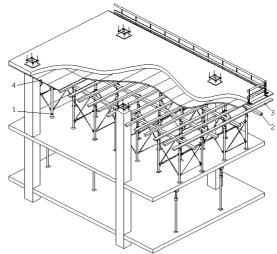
Схема опалубки перекрытия на основе опорных башен:
